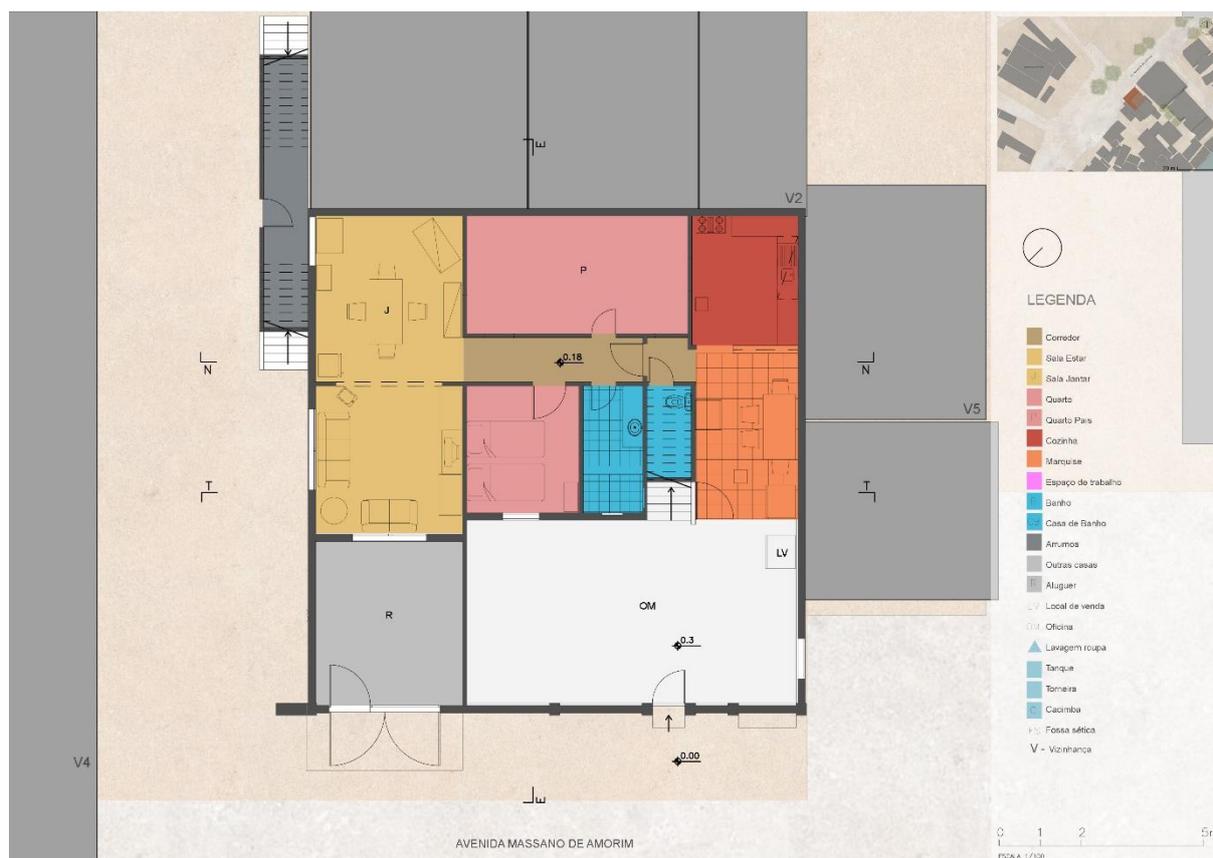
Planta do r/c da Casa 2, em 2020. Levantamento e desenho da autora.
